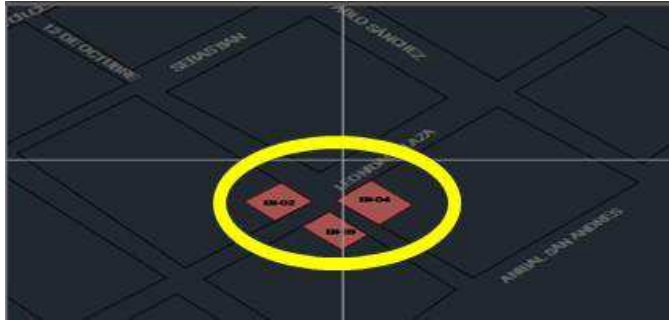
Ubicación de las Edificaciones de la parroquia Charapoto del Cantón Sucre.
